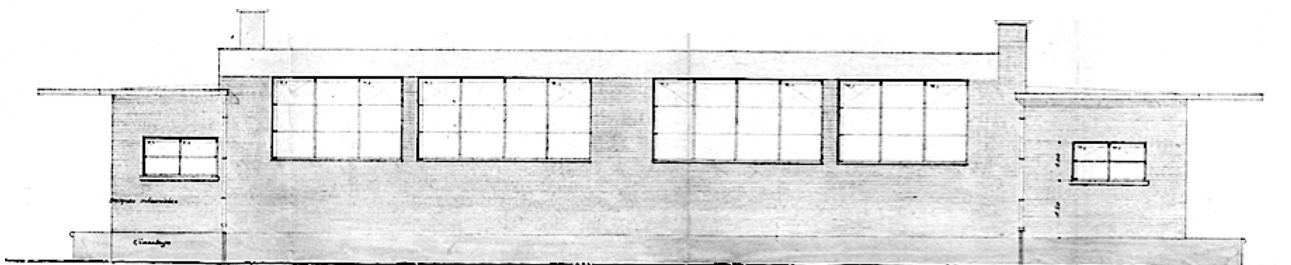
Façade Nord (façade à rue) (Source : Archives de Liège)
